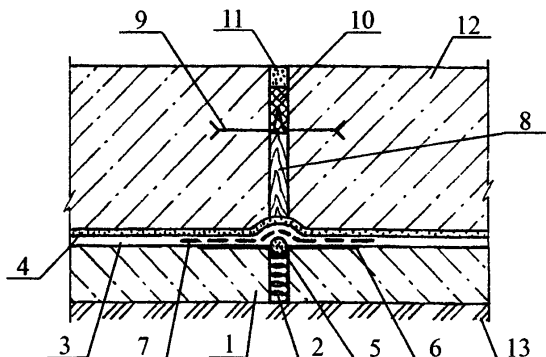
Гидроизоляция деформационного шва при цементной штукатурной гидроизоляции
